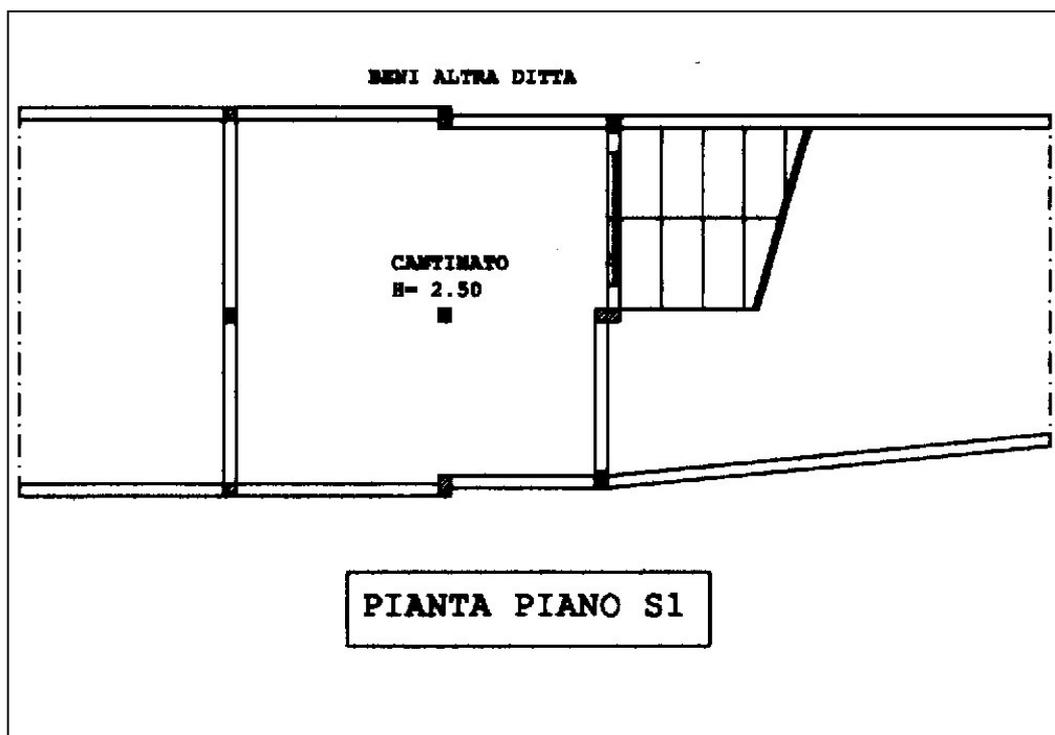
Planimetria in atti al catasto – locale deposito (SUB 4) (alleg. 7)
